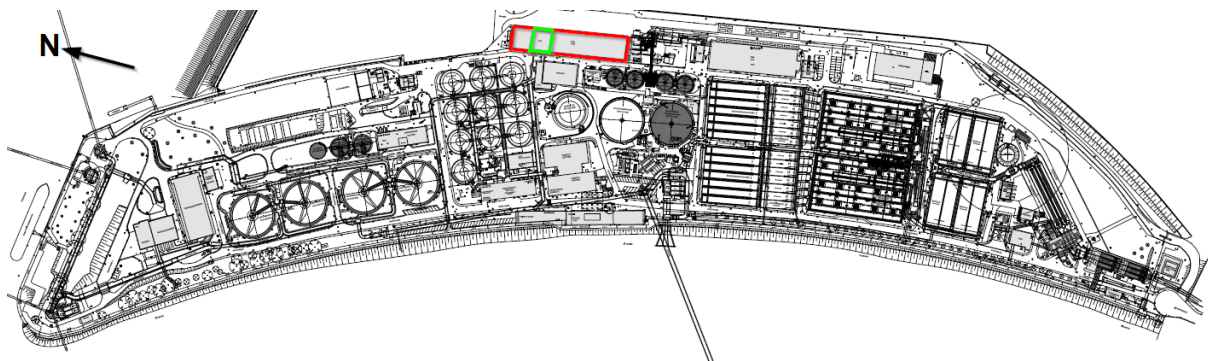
Übersichtslageplan Klärwerk (rot: KETA, grün: zu überwachendes Staffelgeschoss)
